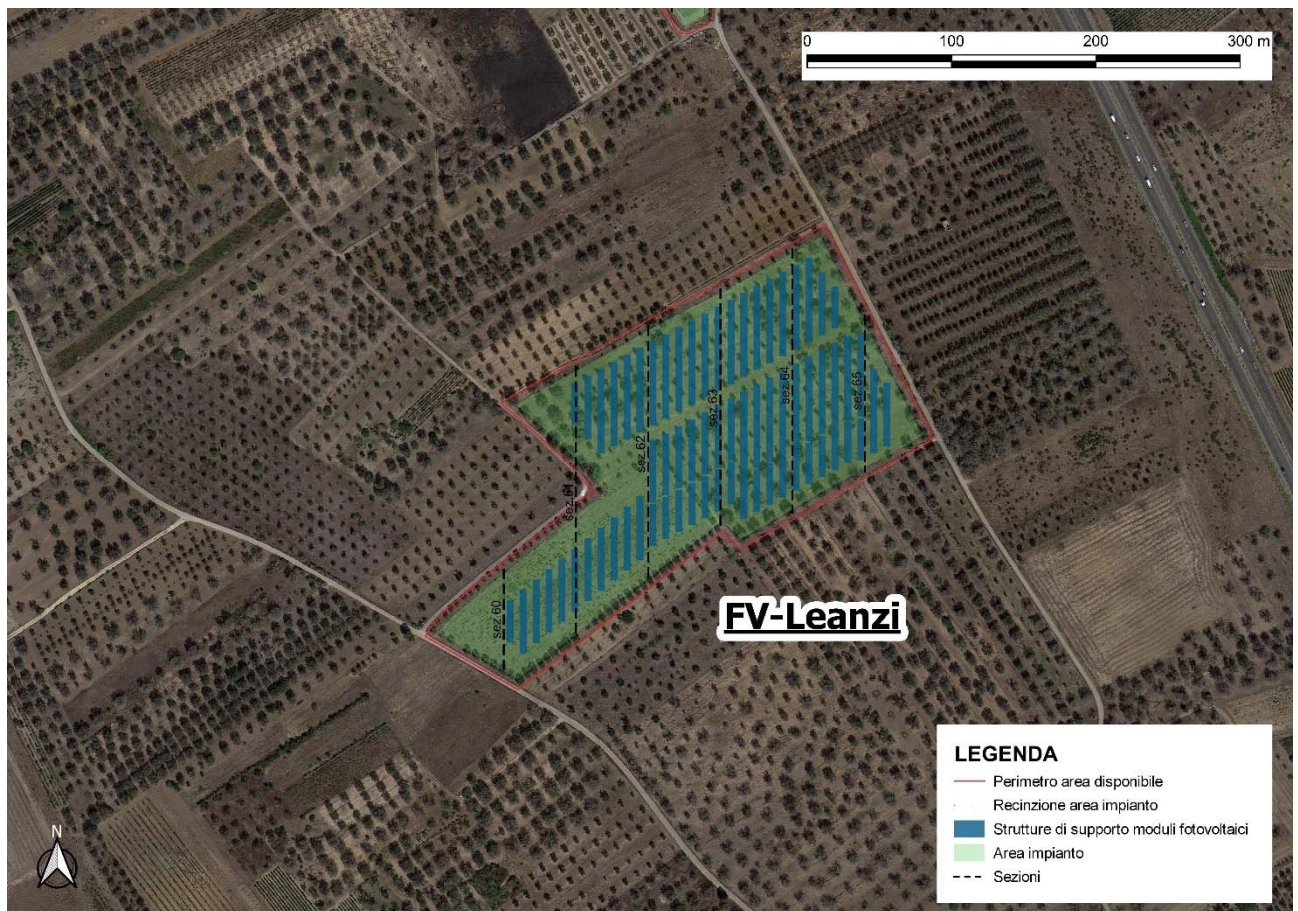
Sezioni sul sito di installazione FV- Leanzi
